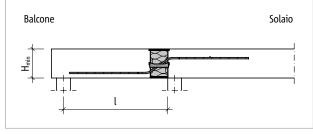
Schöck Isokorb® XT tipo QL: schema statico (XT tipo QL-V1 – V4)
